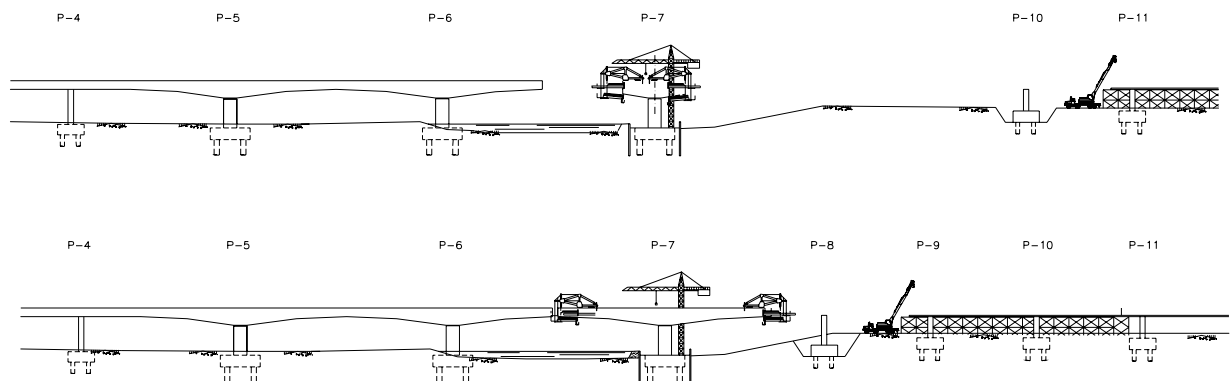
Esquema de proceso constructivo para los vanos centrales.
